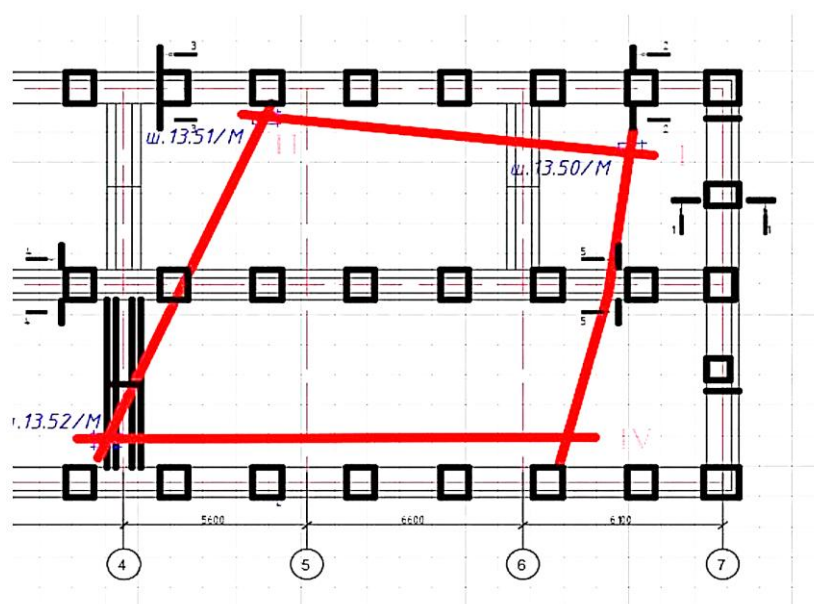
Частина фундаменту будівлі, що підсилюється
